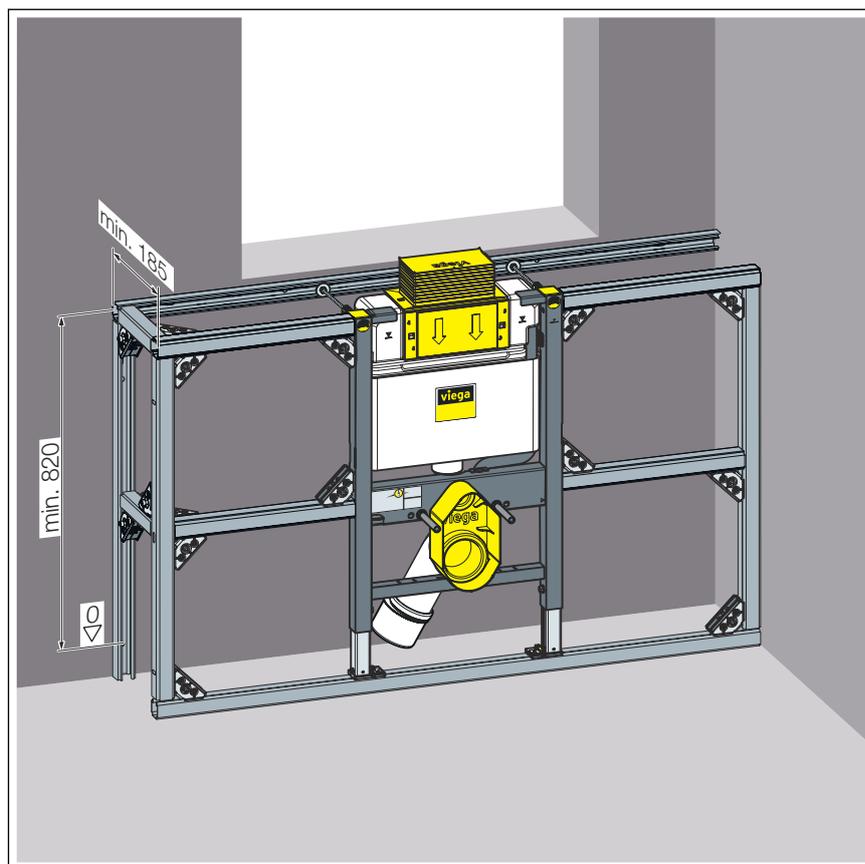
Cotes de montage, hauteur de construction basse (actionnement par le haut)
